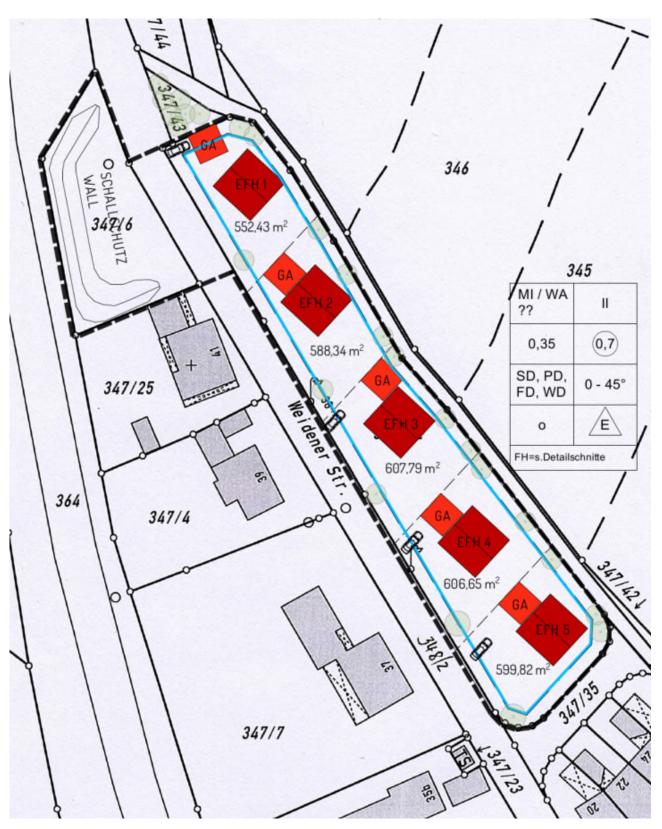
Auszug Lageplan mit Planbebauung, ohne Maßstab
